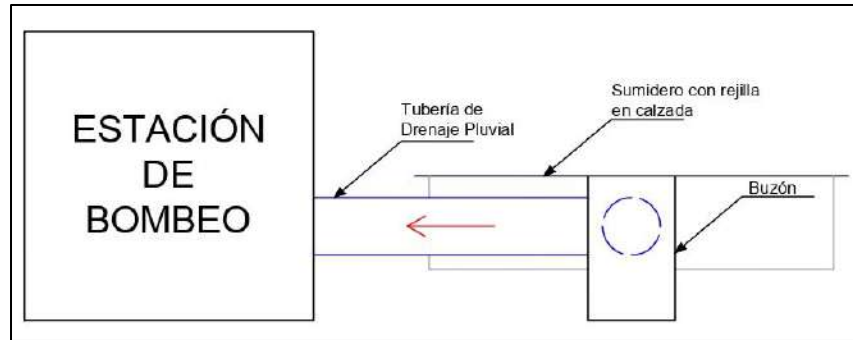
Esquema de sistema de drenaje pluvial – Perfil transversal
